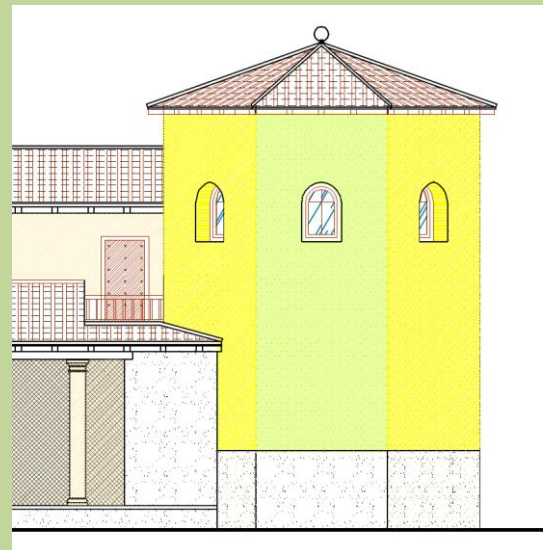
Alzado de la torre -I- octogonal oriental (reconstrucción virtual). CGS.
